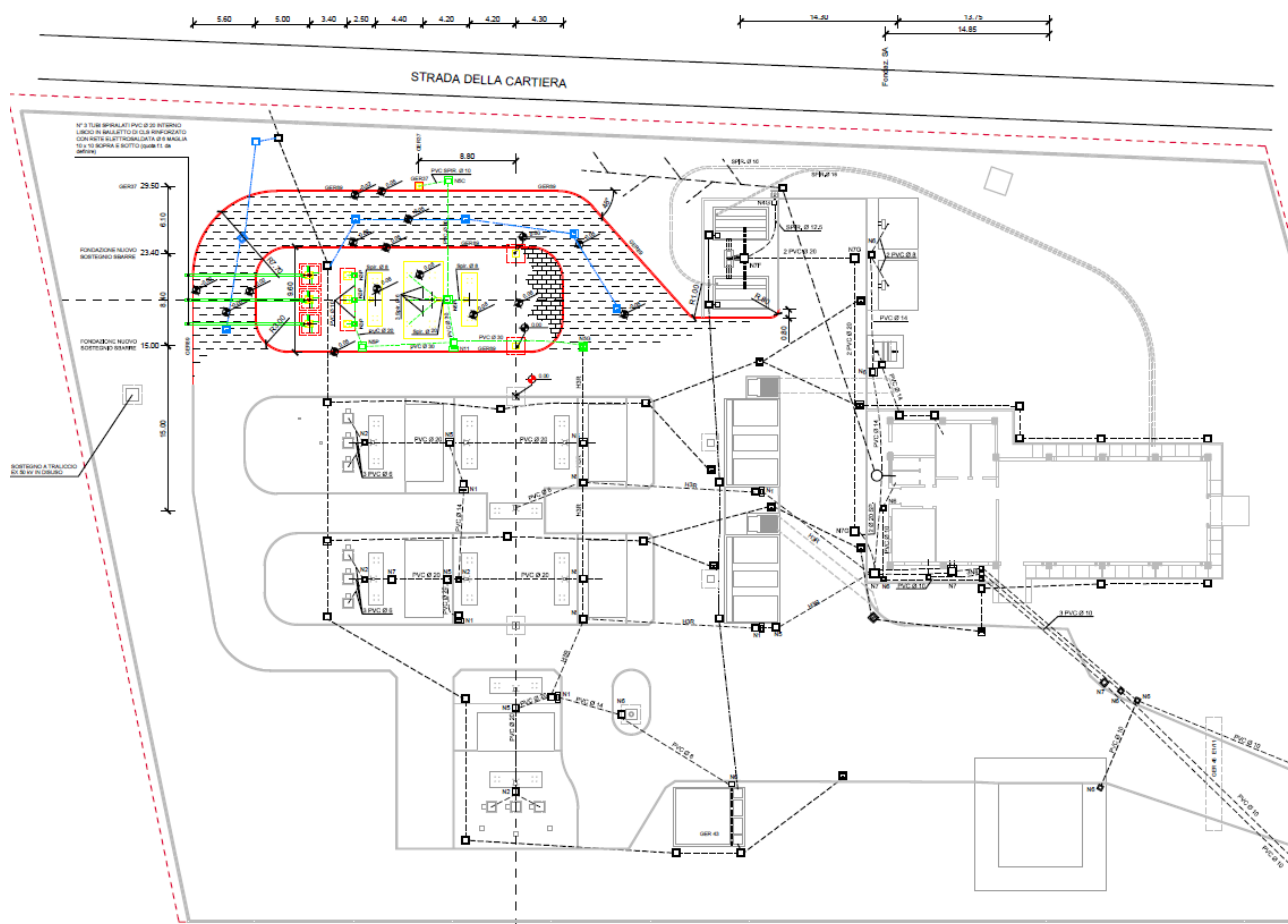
Planimetria stallo da realizzarsi in cabina primaria
